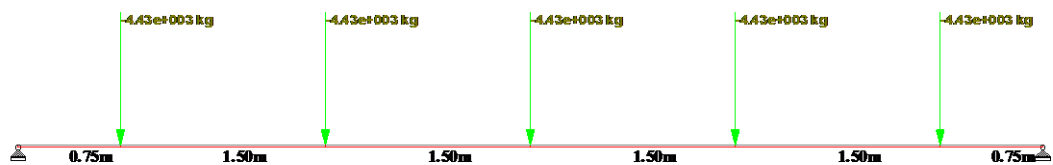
Momen Akibat beban mati plat lantai yang bekerja pada gelagar memanjang
